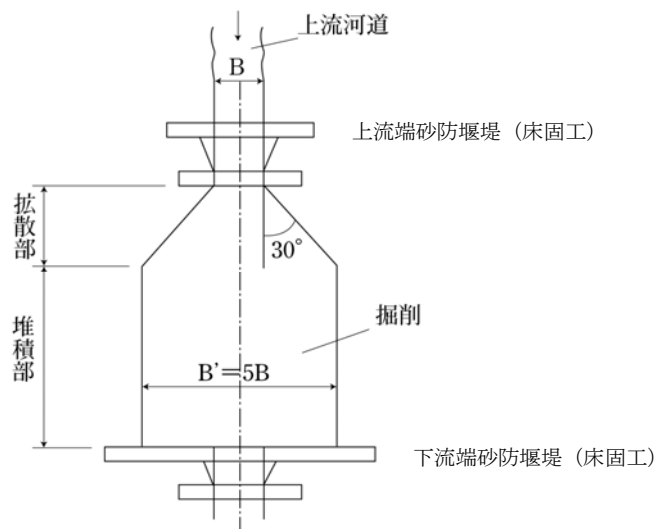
沈砂地の平面形状（将棋駒形の例）
